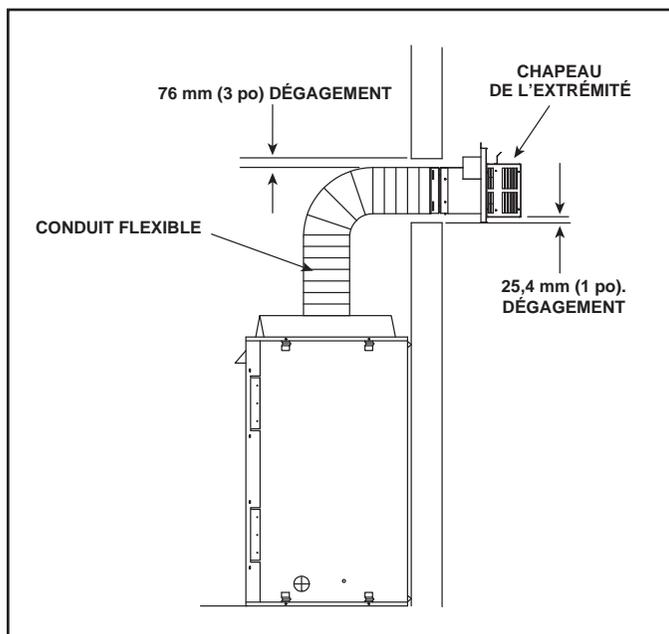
Conduit d'évacuation flexible – Foyer générique illustré
